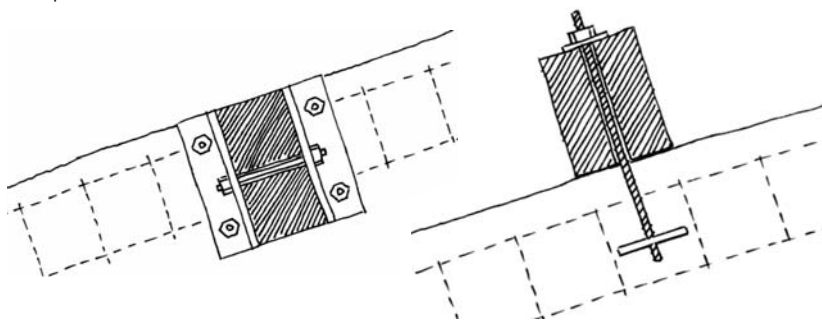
Fixation d'une panne sur chaînage de rampant.
